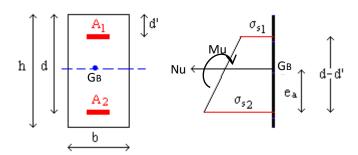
Flexion composée, section rectangulaire et N effort de traction
